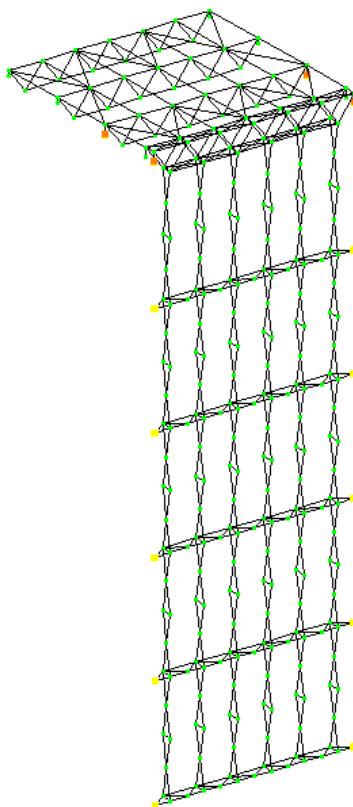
Расчетная схема конструктивного решения фасадной системы
